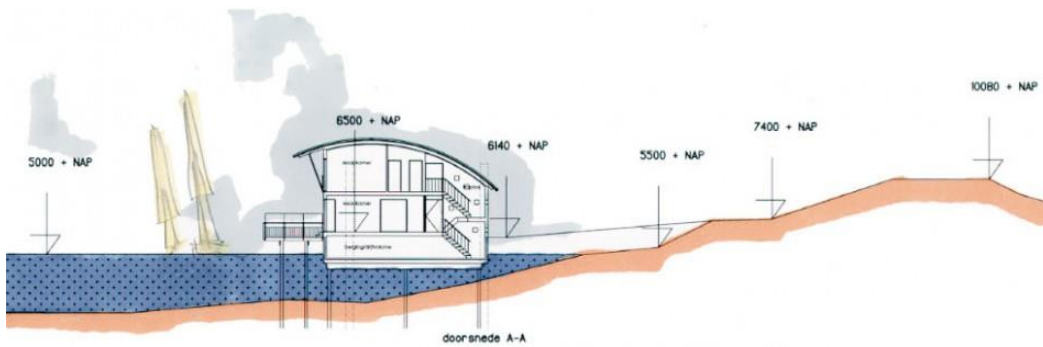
Rumah Amphibi dengan konstruksi tiang penahan baja di Maasbommel, Belanda
